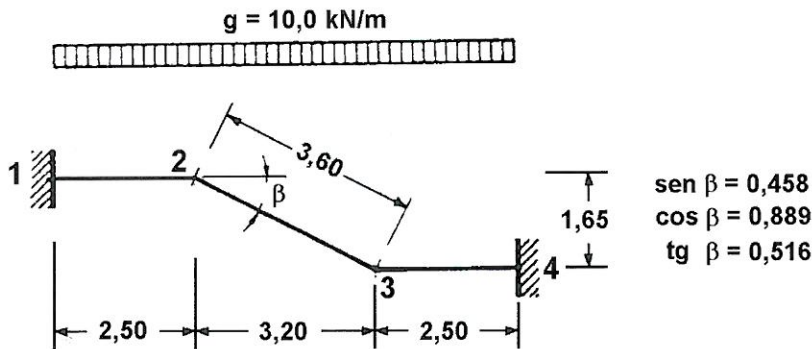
Laje de eixo quebrado encastrado nos apoios
